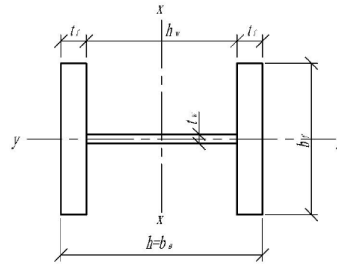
Схема зварного перерізу верхньої частини колони
